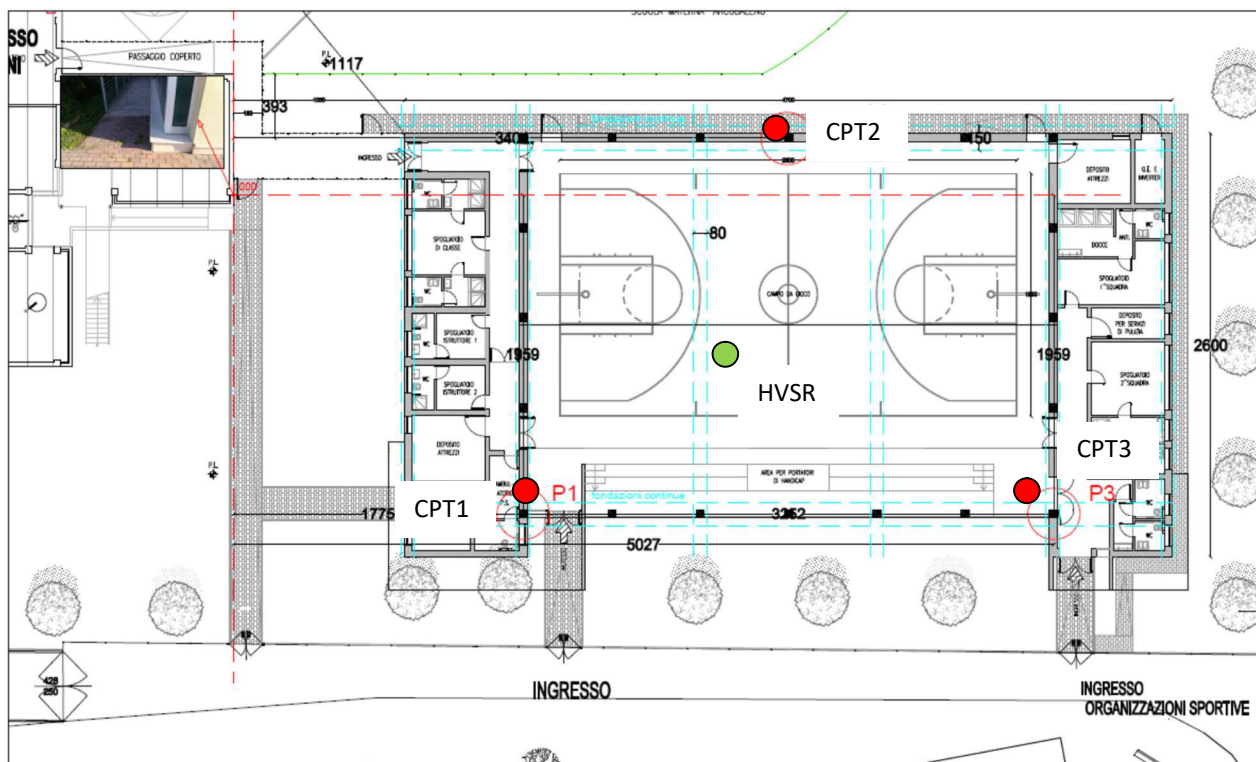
Planimetria di progetto riportante l'ubicazione delle indagini eseguite.
